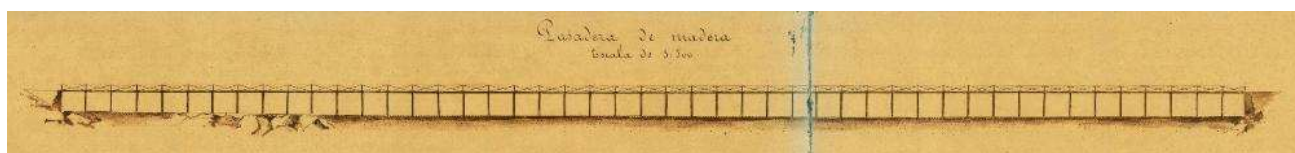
Alzado longitudinal de la “pasadera” de madera. Plano original de Eduardo Vila (1887).
